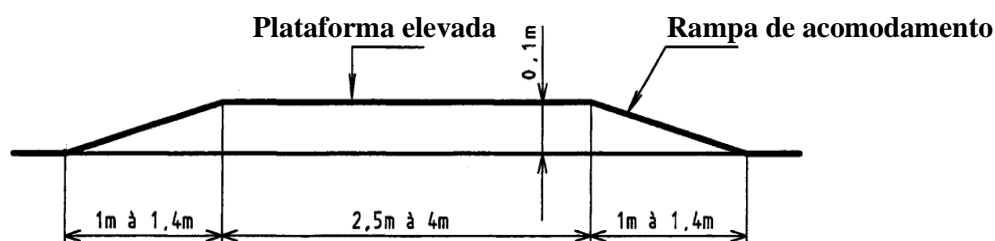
Perfil Trapezoidal das travessias pedonais elevadas
